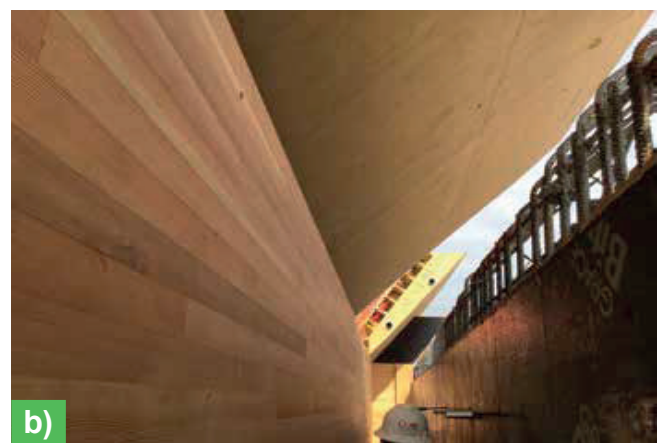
La pared curva “característica” del “Skylight Pavilion” requería un sistema de encofrado extremadamente complejo: (a) las torres de encofrado iniciales sobre el sitio, adyacentes a la grúa torre (b) el acabado de la tabla machihembrada fue especialmente desafiante de crear en la superficie curva; (c) se requería un espaciado uniforme de los tirantes; y (d) la escala del muro se aclara con esta foto del equipo que conmemora la colocación final del concreto del muro.
